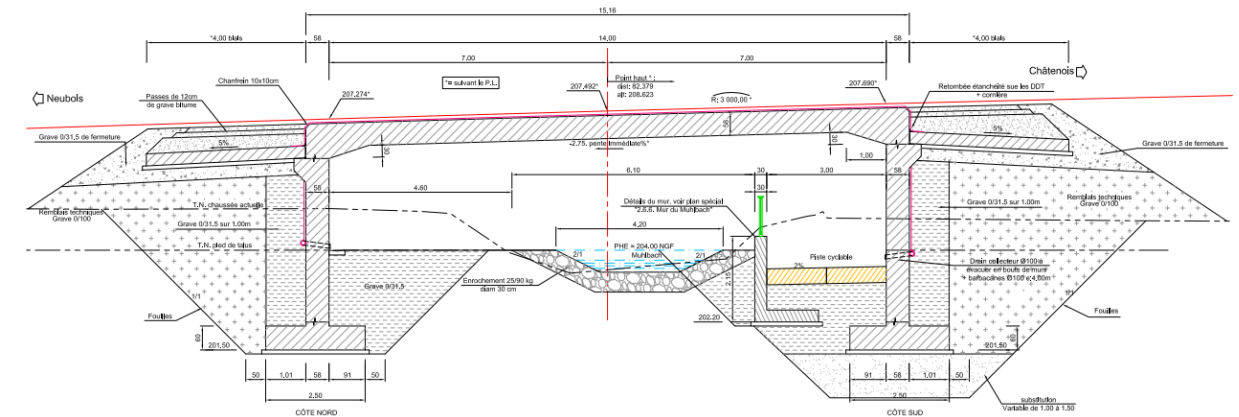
Coupe transversale de l'ouvrage OA1bis
